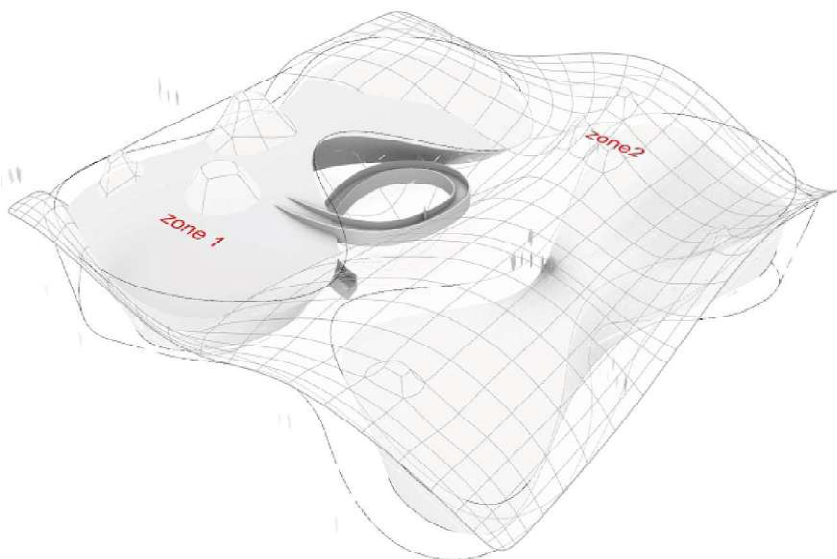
Formfindung, 1.Obergeschoss, Verbindungsrampe
